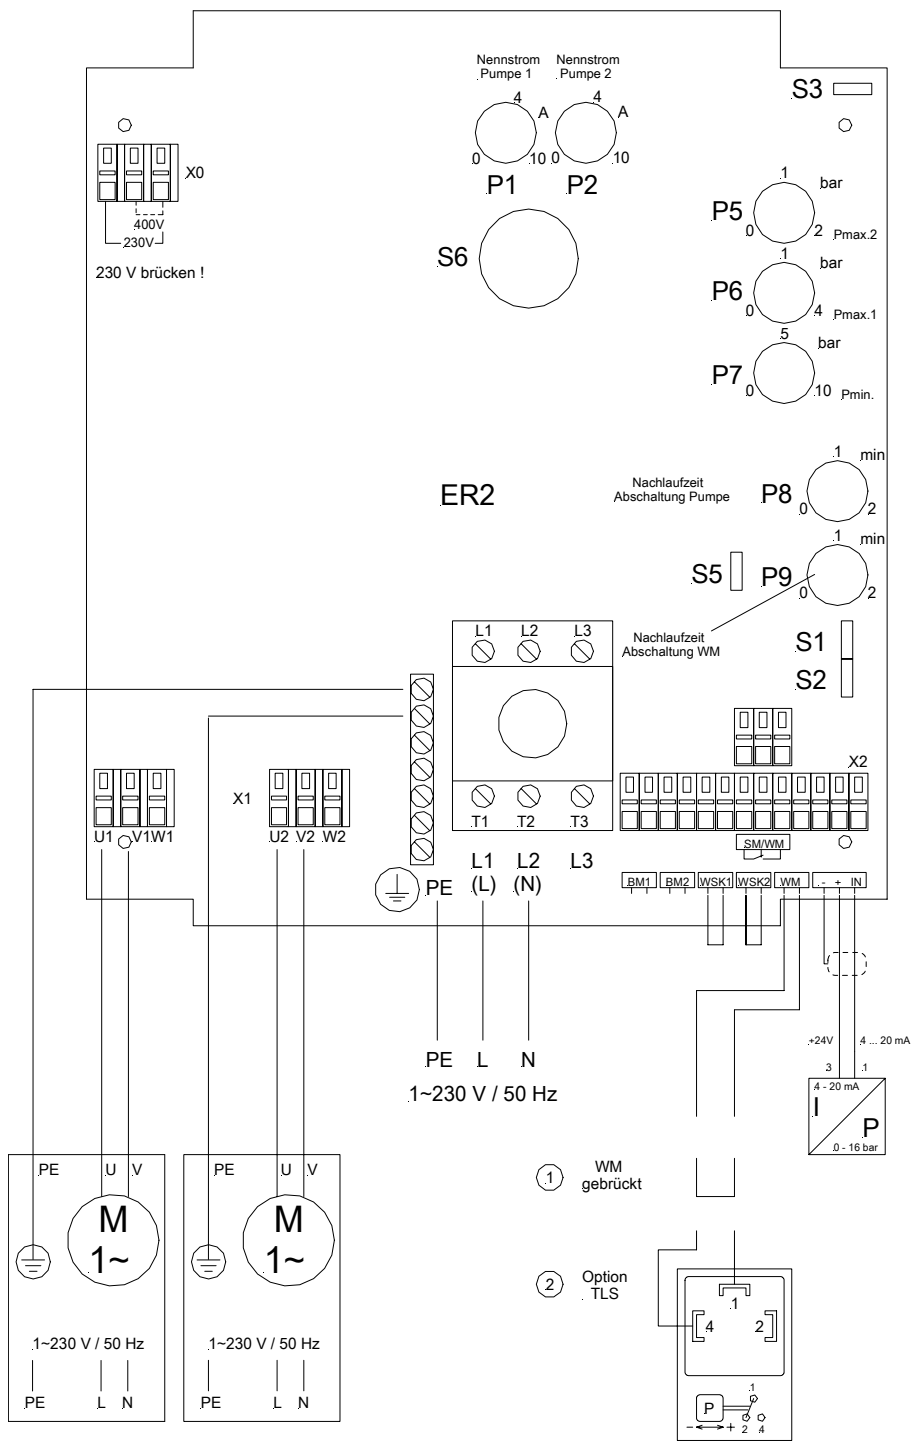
Anschlußbelegung der Platine der Pumpensteuerung
